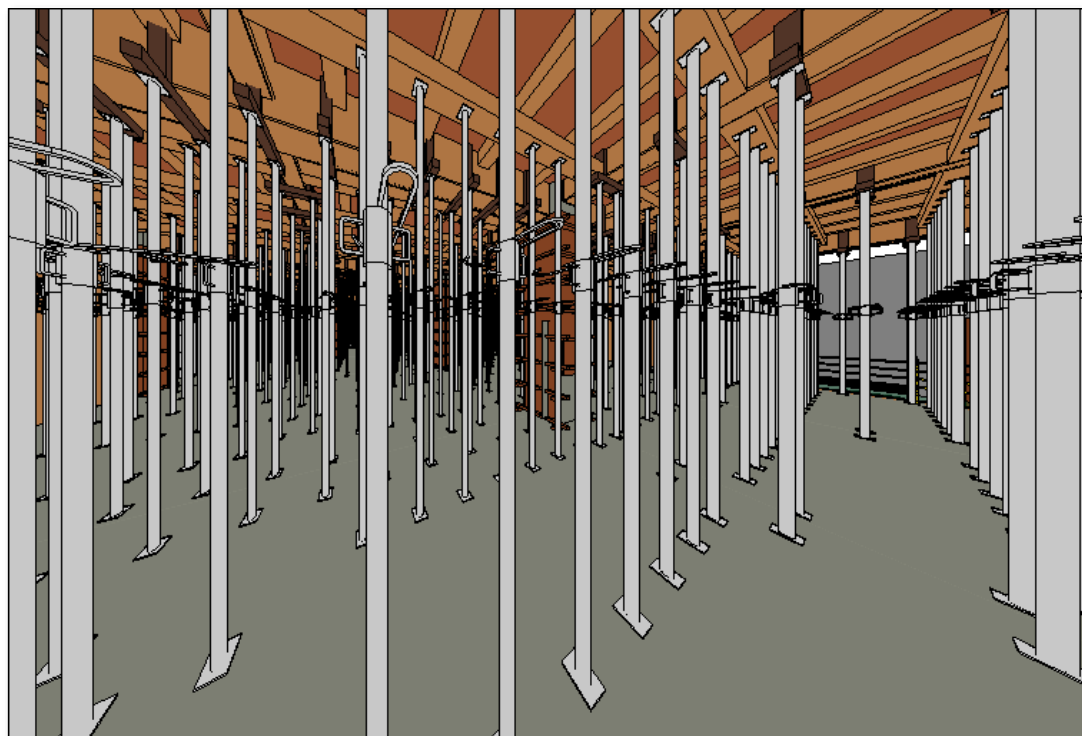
Vista de Encofrados de Vigas y Losas.
